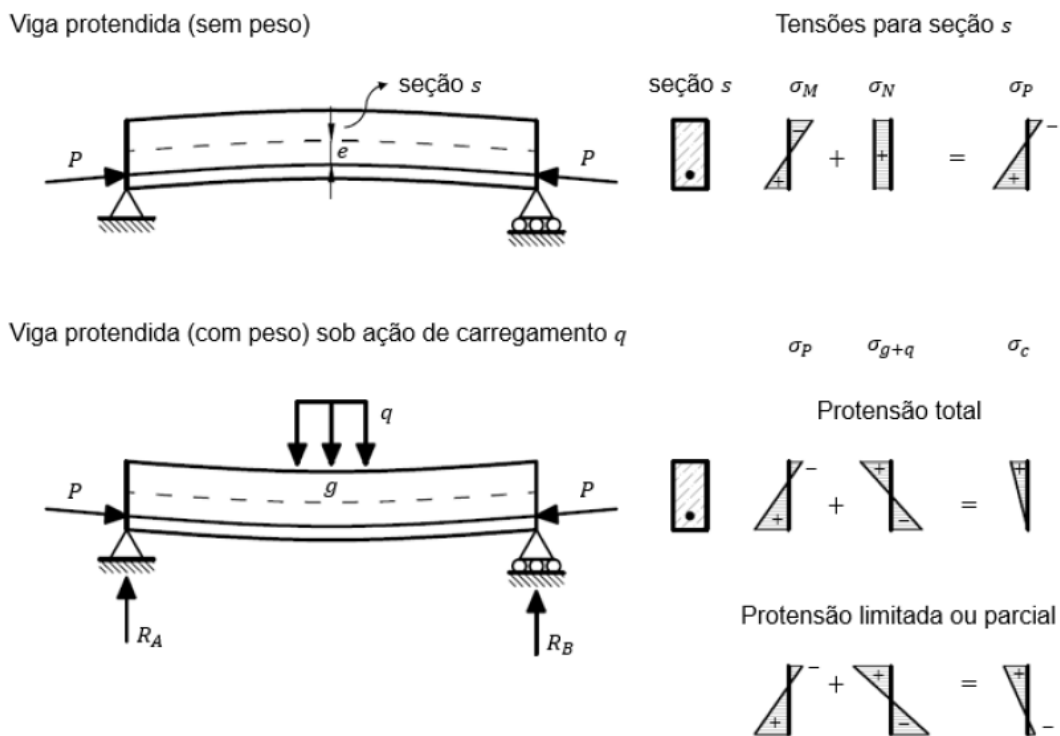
Esquema de tensões para viga protendida (SABA, 2018)
